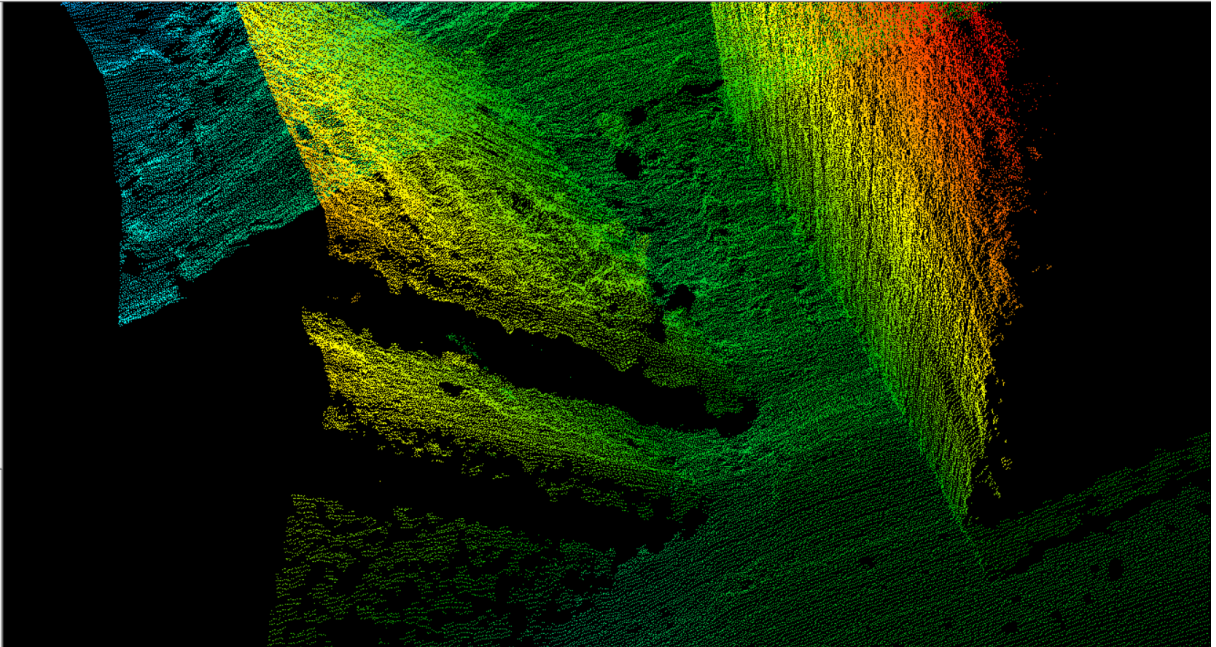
Superestructura pila P6 colapsados junto a cimentación y paramento frontal pila P9.
